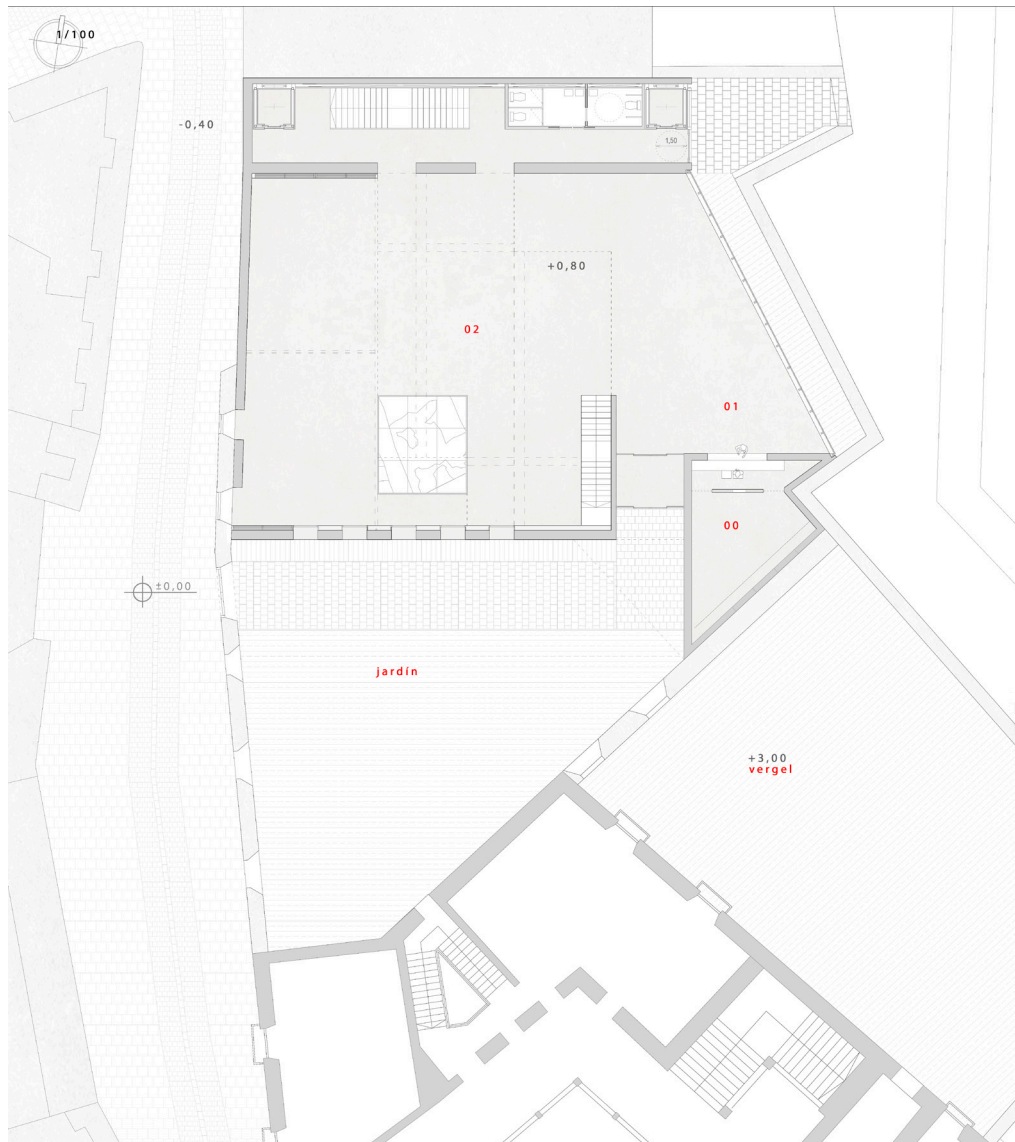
Plantas zócalo Fuente: Elaboración propia
